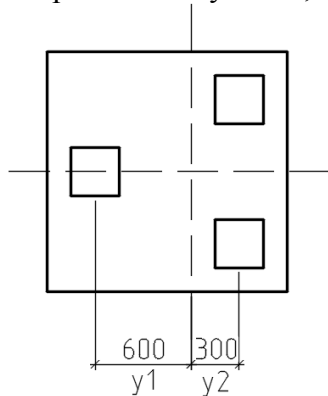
Схема с указанием расстояний от оси куста до каждой сваи
